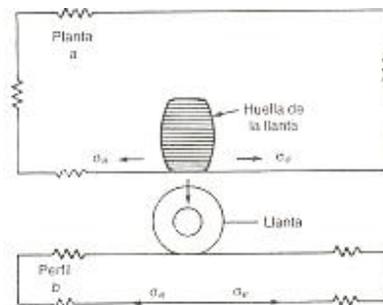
Esfuerzos de tensión que se presentan en pavimentos rígidos, cuando la huella de una llanta es tangente a una sola orilla de la losa (esfuerzos de orilla); (a) planta, (b) sección.
